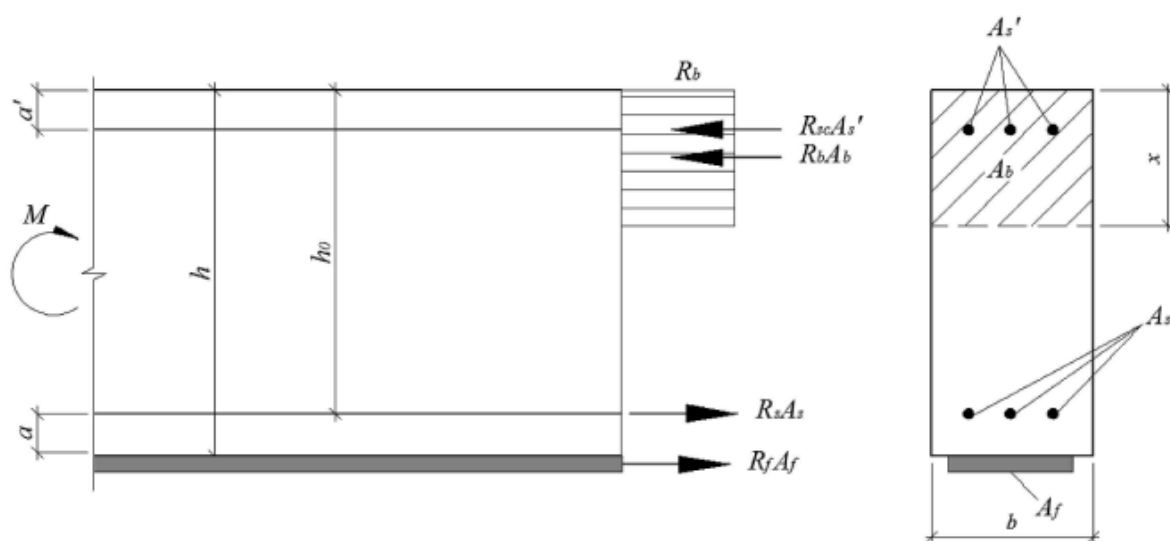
Расчетная схема нормального сечения, усиленного системой внешнего армирования
